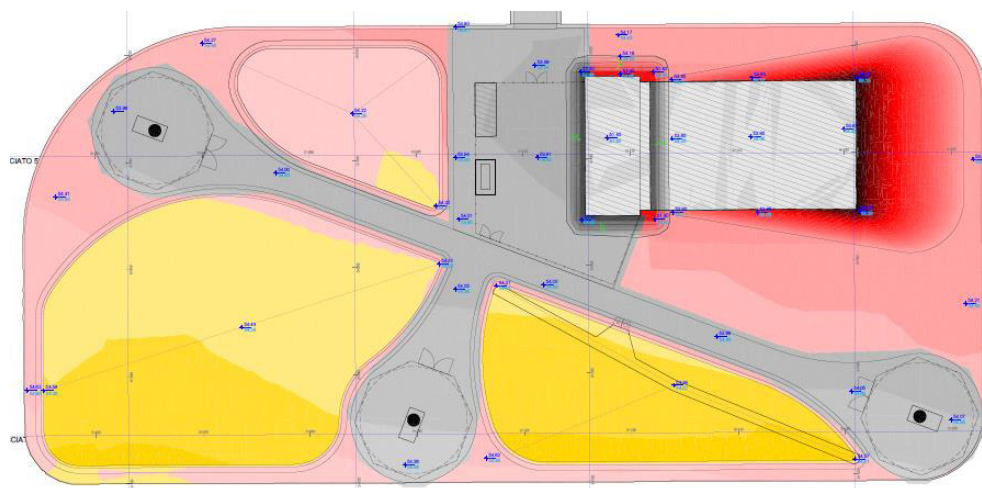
Planimetria fase 2 movimenti terra con indicazione in giallo delle aree soggette a scavo per realizzazione depressioni terreno, e in rosso i rinterri e rilevati.
